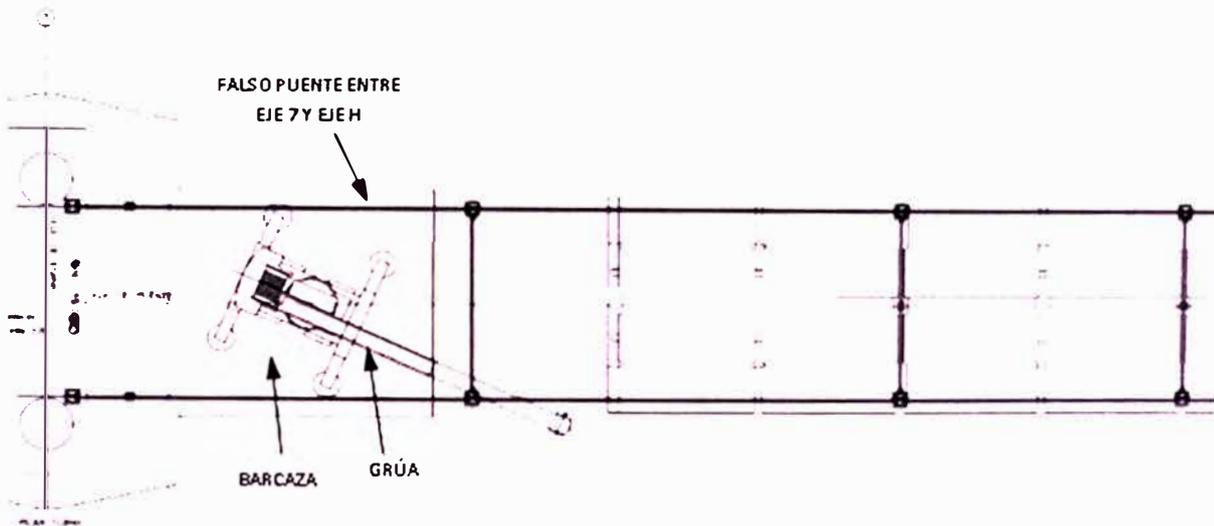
VISTA DE PLANTA MONTAJE DEL FALSO PUENTE
